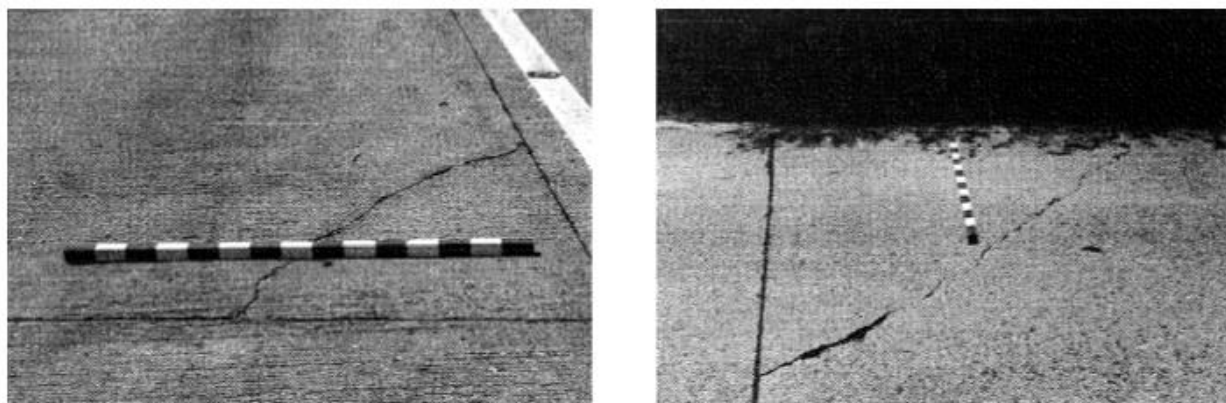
Fissure oblique d'une chaussée rigide
